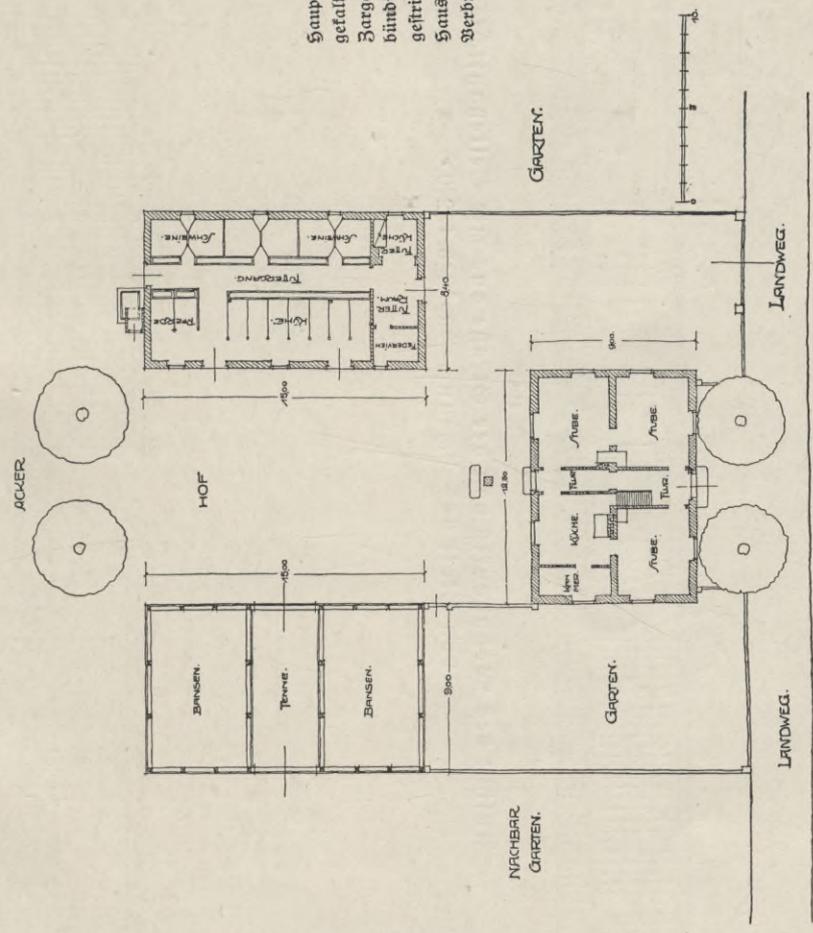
Grundriß des Gehöfts. Maßstab 1:400.
